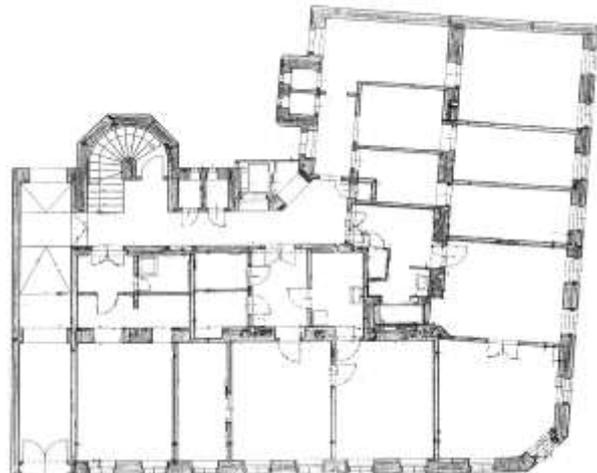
Grundriss Rokitanskygasse 18
